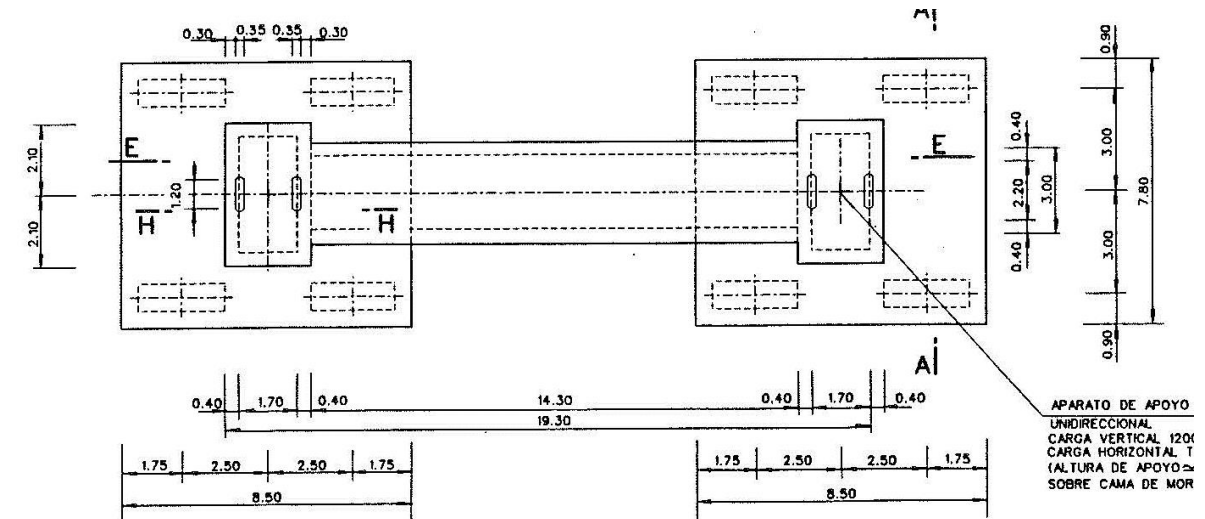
Planta de la cimentación de las pilas P-13 y 16 (copiada del Proyecto Modificado n° 1)
